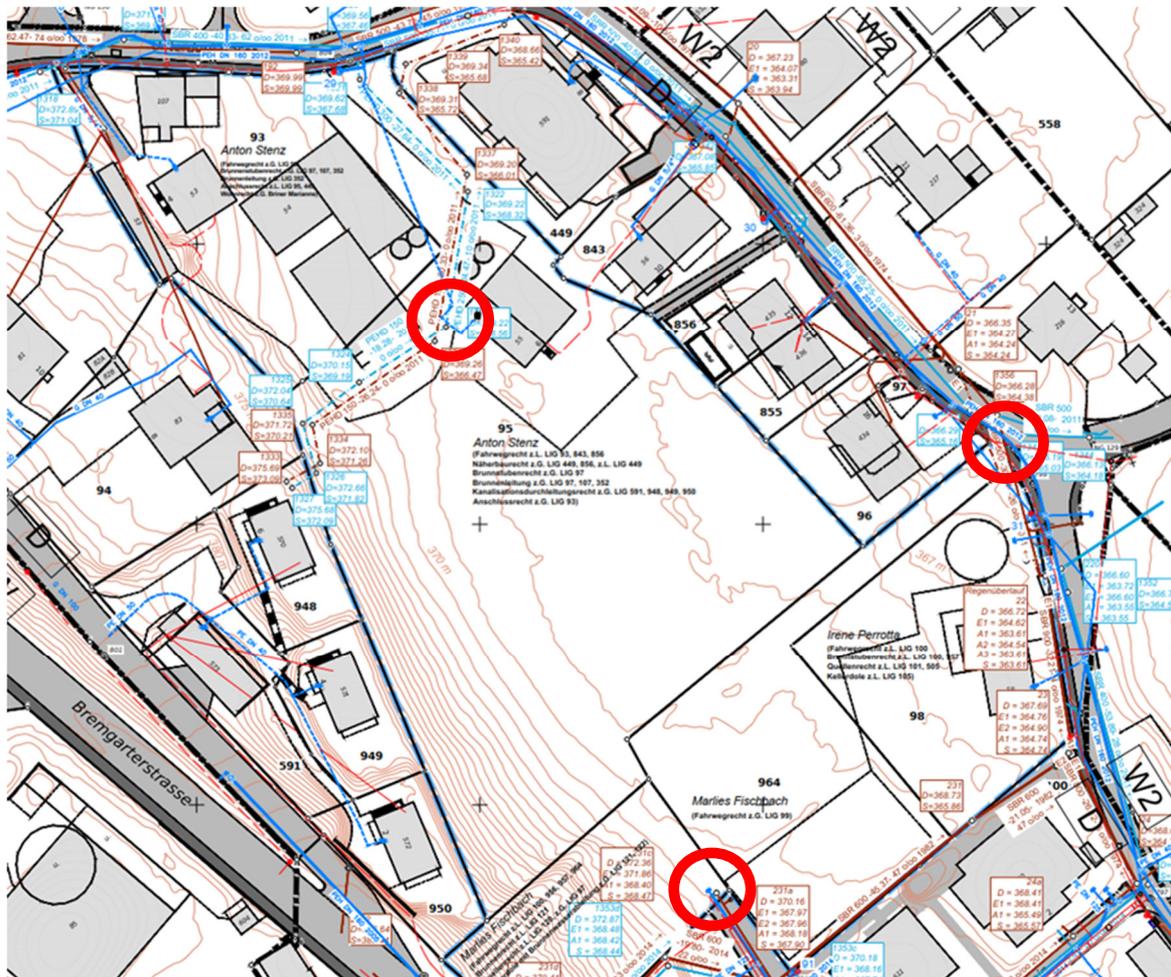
Ausschnitt Werkleitungsplan (braun strichliert: Mischabwasserleitungen, hellblau strich-punktiert: Meteorabwasserleitungen, blau strichliert: Wasserversorgungsleitungen)
